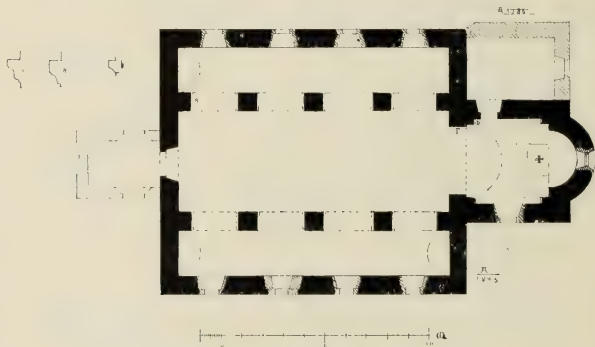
Odendorf. Katholische Pfarrkirche. Grundriss.
